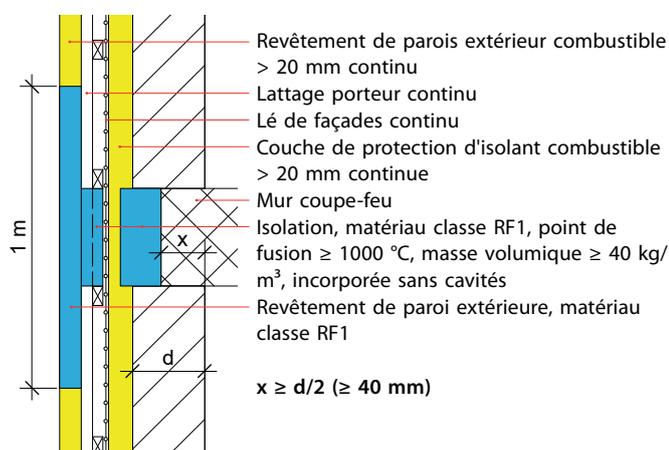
Revêtement de parois extérieur/couche de protection isolante combustible > 20 mm; raccordement de murs coupe-feu au mur extérieur (dessin d'après AEAI)
